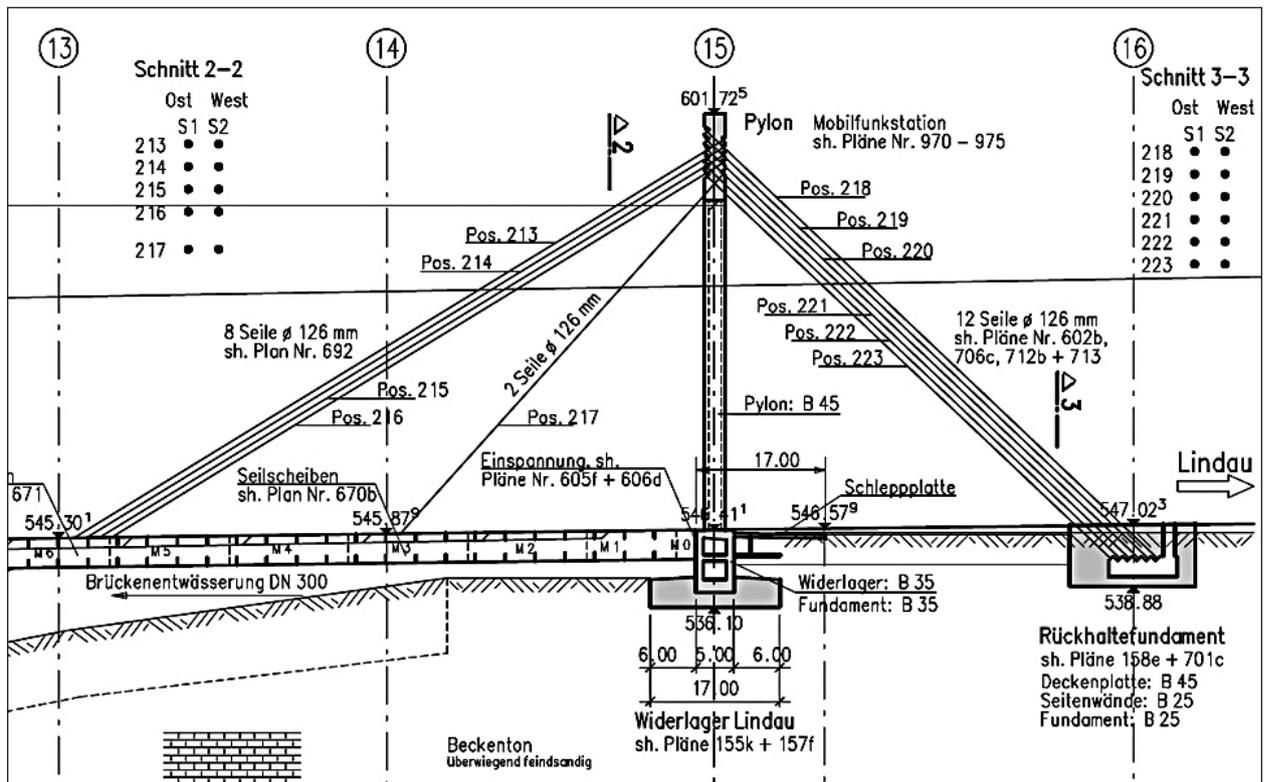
Längsschnitt der Talbrücke Obere Argen (Teil mit oberhalb der Fahrbahn liegenden Seilen)
